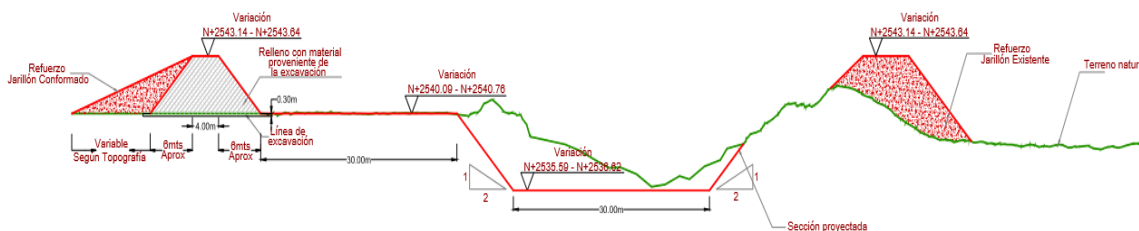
Sección típica 1 de corte transversal Río Tunjuelo.
